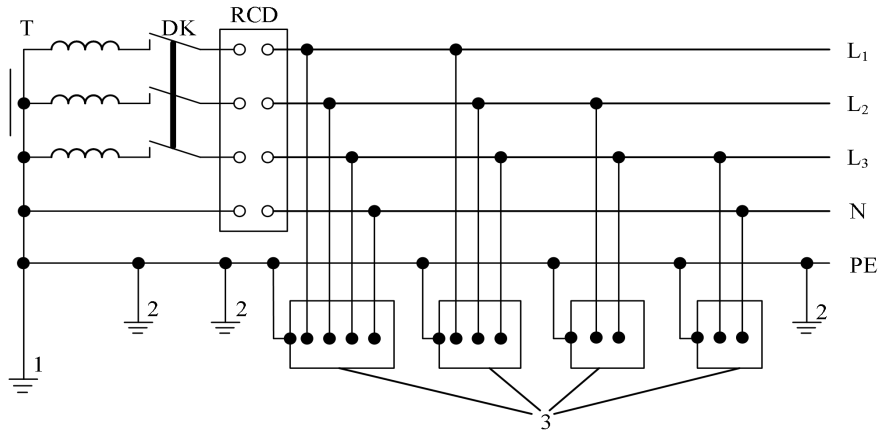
专用变压器供电时 TN-S 系统示意图
